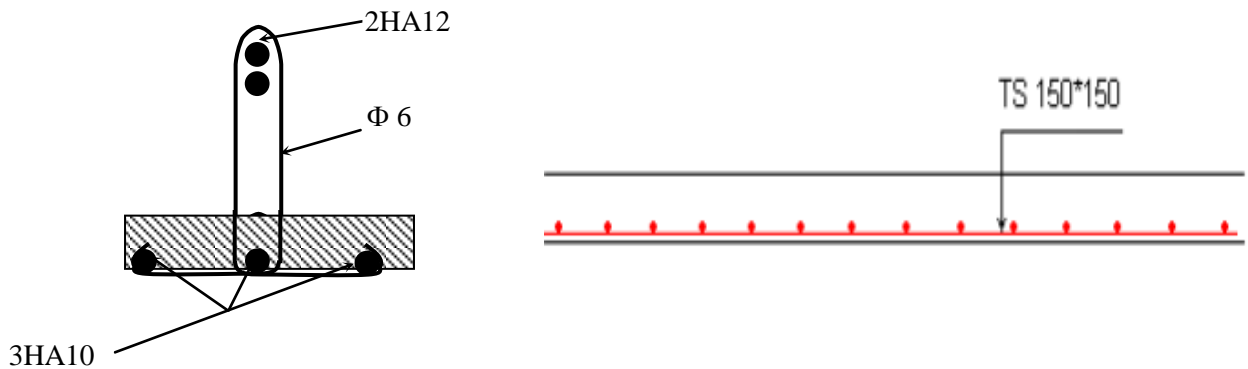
Ferraillage de la dalle de compression et poutrelles
